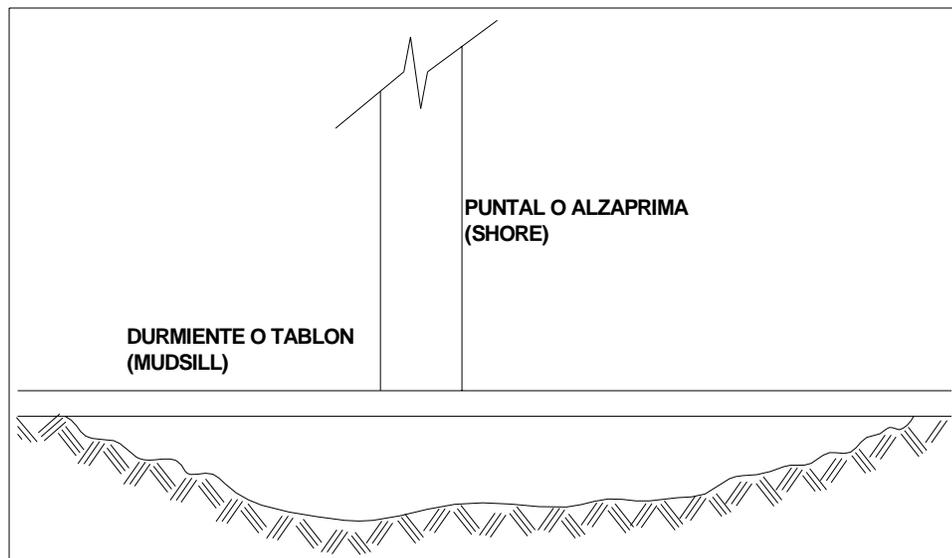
a – Posición inadecuada bajo el durmiente.
